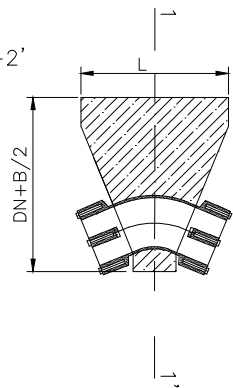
# DETAIL ZAJIŠŤOVACÍCH OPĚRNÝCH BLOKŮ
